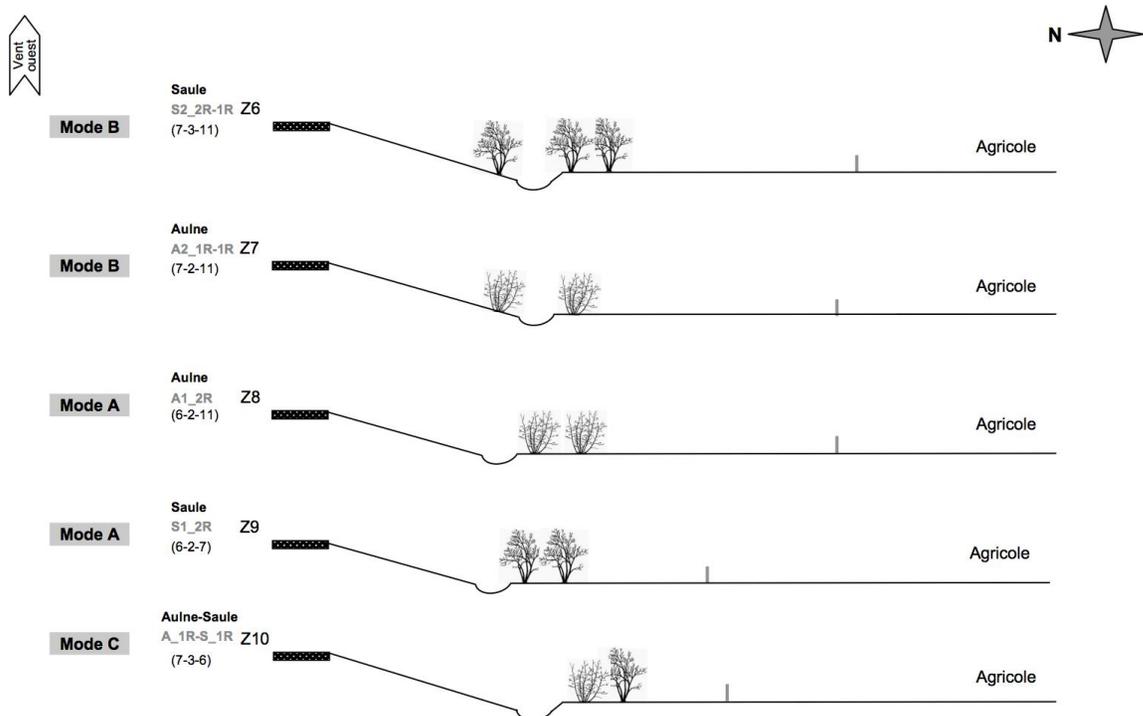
Coupe transversale des zones de plantation sur le côté sud de l'autoroute 30
